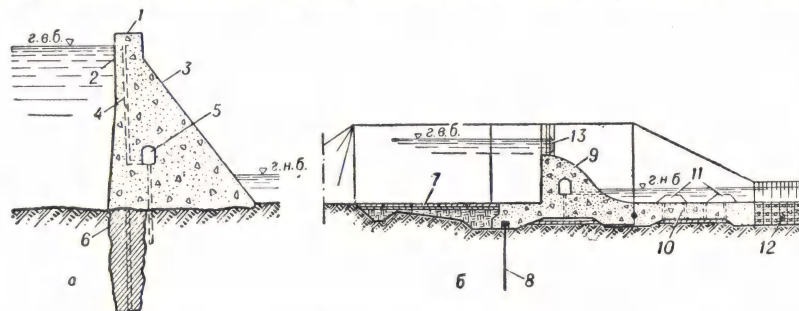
Бетонные гравитационные плотины (в поперечном сечении): а — на скальном основании; б — на нескальном основании; 1 — гребень плотины; 2 — верхняя грань; 3 — низовая грань; 4 — дренаж тела плотины; 5 — дренажная и смотровая галерея; 6 — цементационная завеса; 7 — понур; 8 — шпунтовая стенка; 9 — водослив; 10 — водобой; 11 — гасители энергии потока; 12 — рисберма; 13 — затвор.
